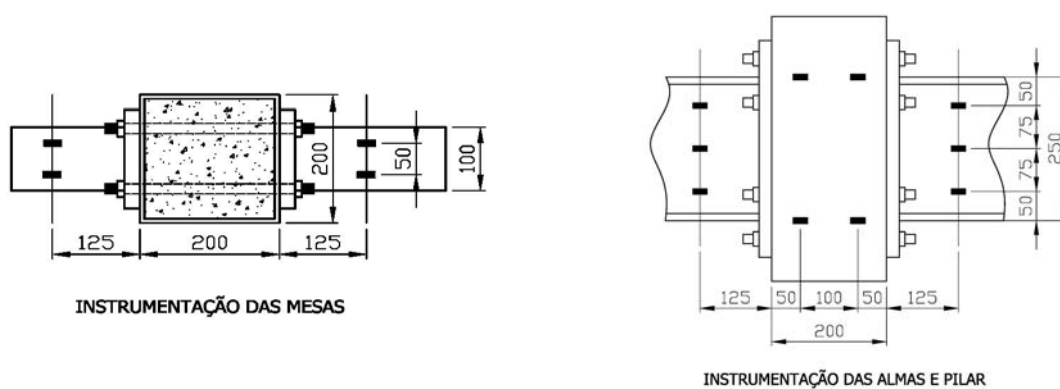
Localização dos extensômetros nas vigas (Unidade: milímetro).
